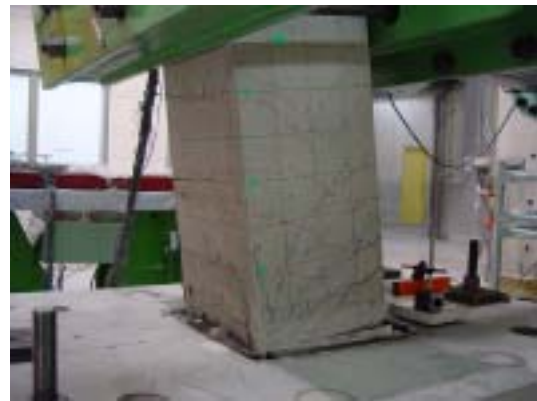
No-3 試験体水平変位 135mm 時 (部材角 1/6.7) の損傷状態
